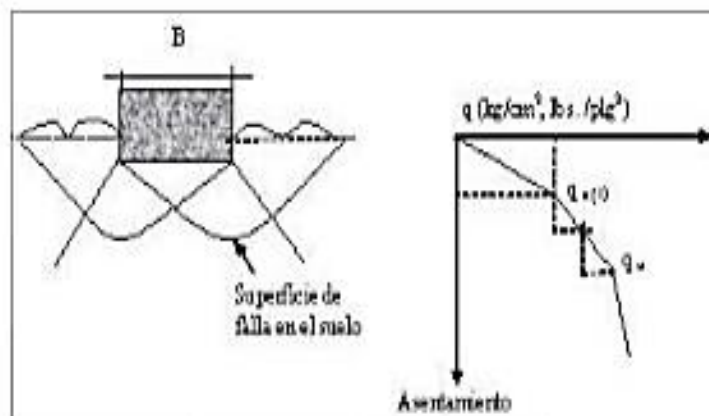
Falla local por corte. (Fuente: Vesic, 1973).
